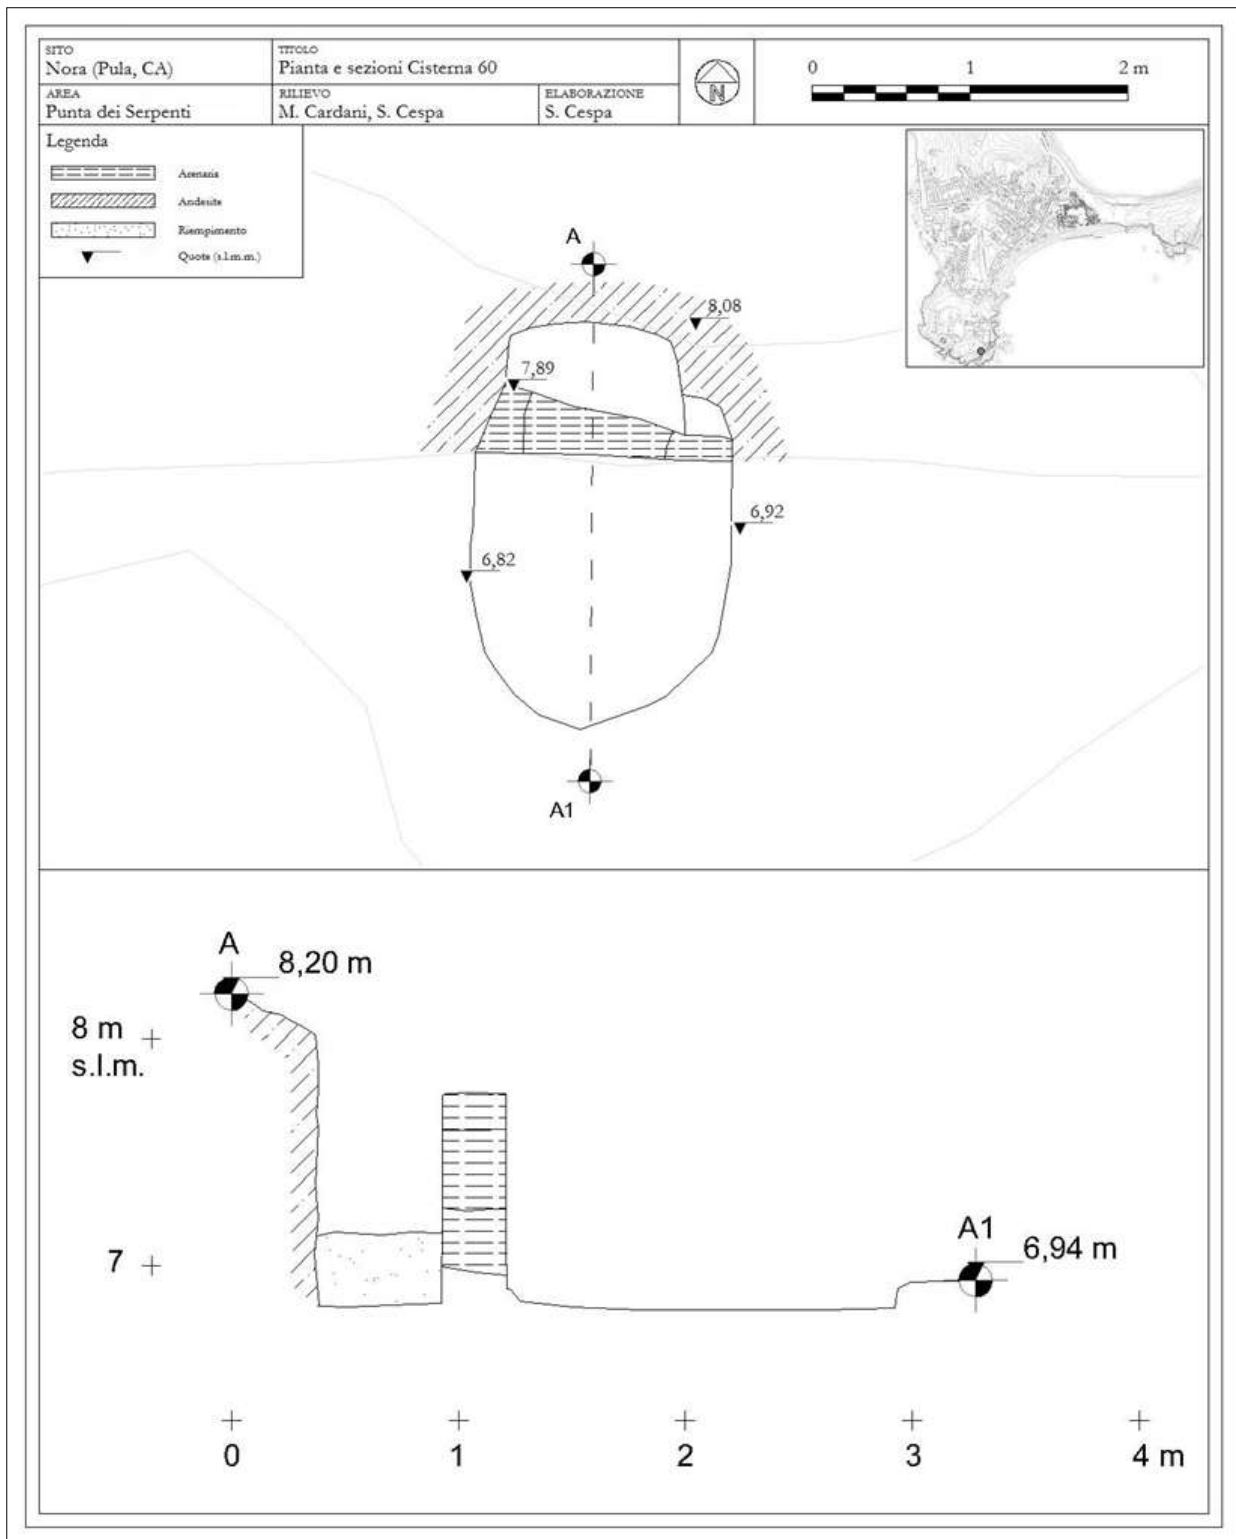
Pianta e sezione della cisterna 60 (elaborazione dell'autore).
